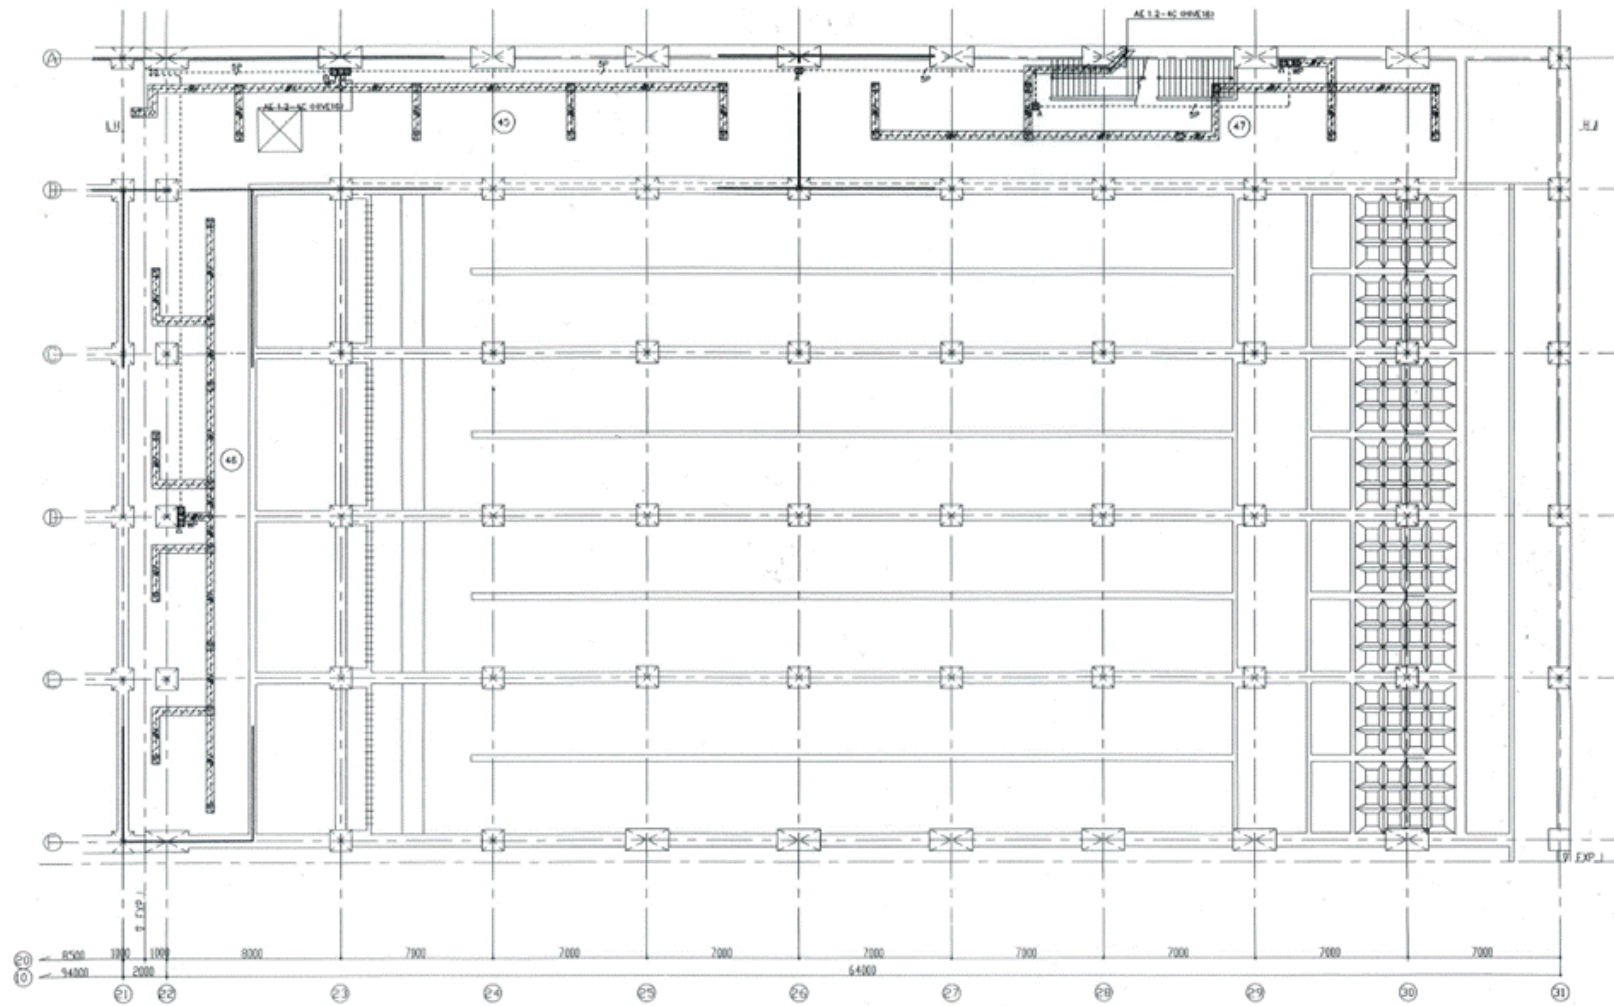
系水处理棟（最終沈殿池） 地下2階平面図（既設）
